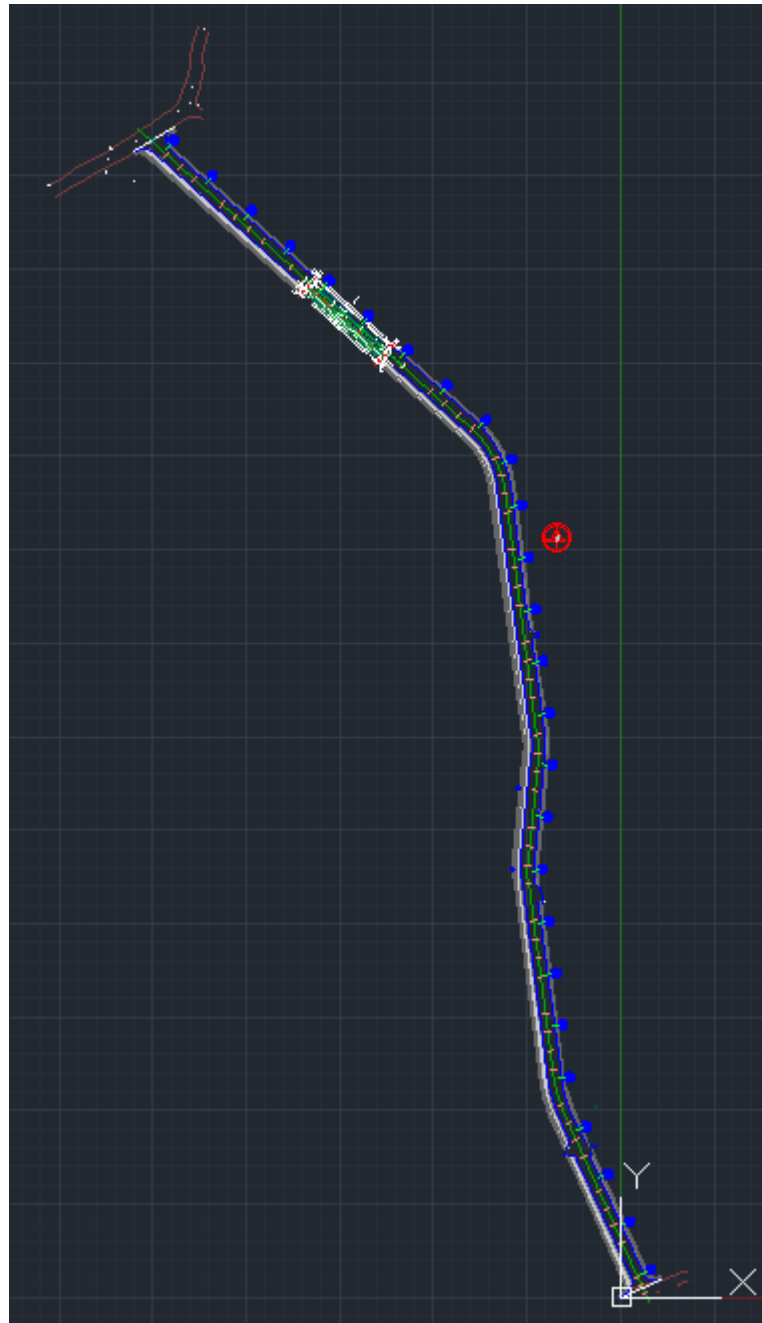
Plano base con los datos del levantamiento en zona de vía vehicular (vista en planta).
